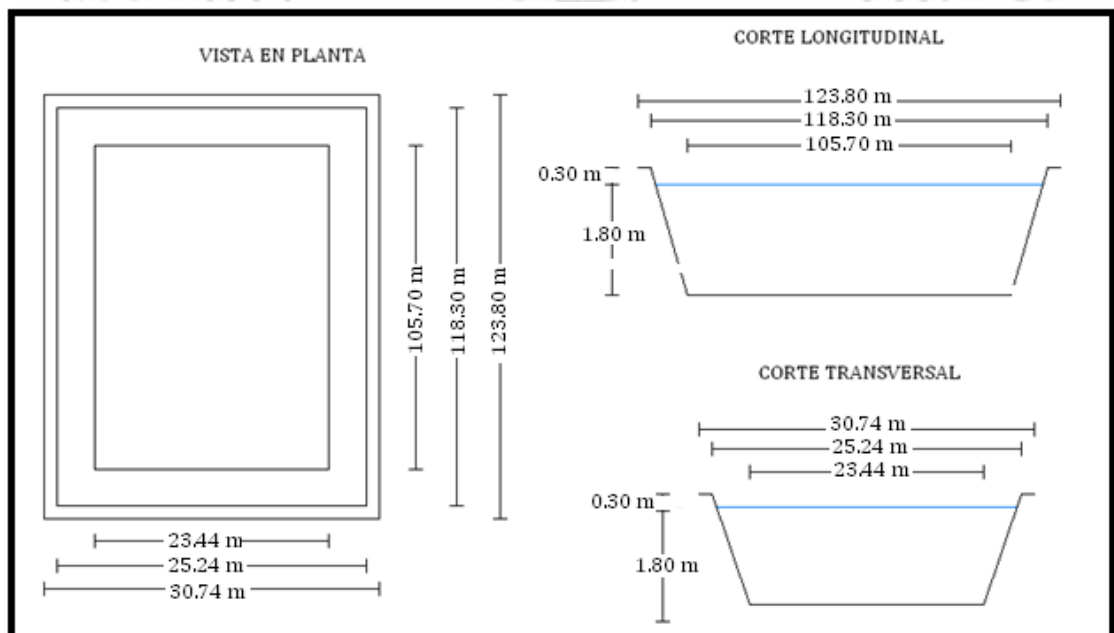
Esquema en planta, transversal y longitudinal de la laguna facultativa
